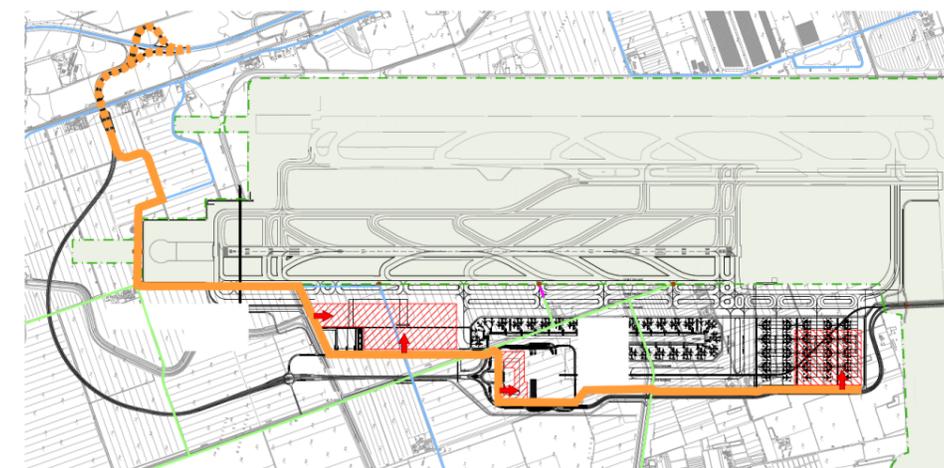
Planimetria della viabilità di accesso nelle fasi iniziali
